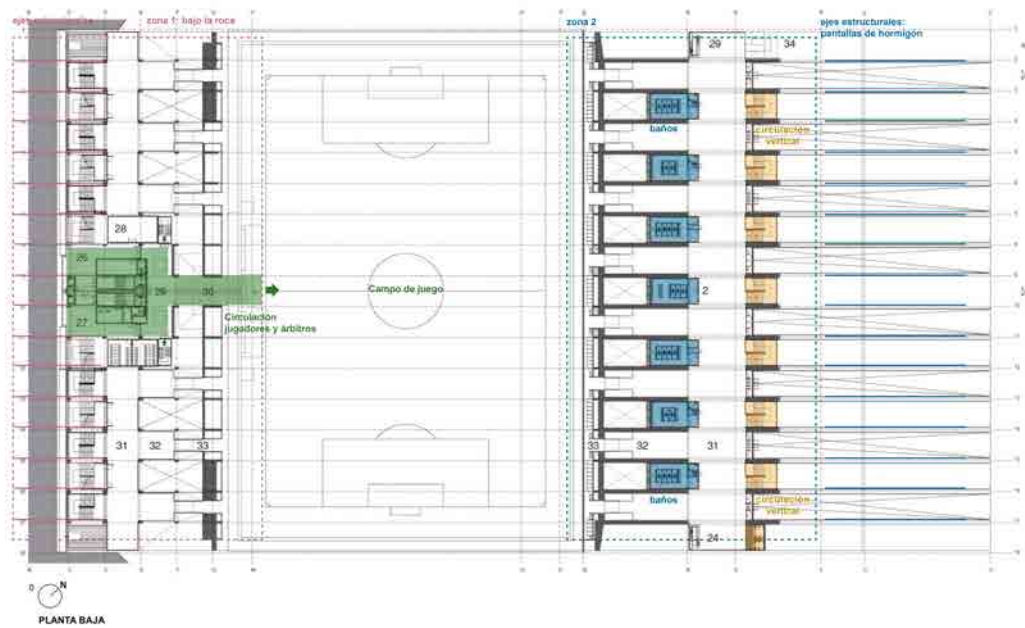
Programa Planta Baja. Fuente: www.arquitecturaviva.com. Elaboración: Autores.
